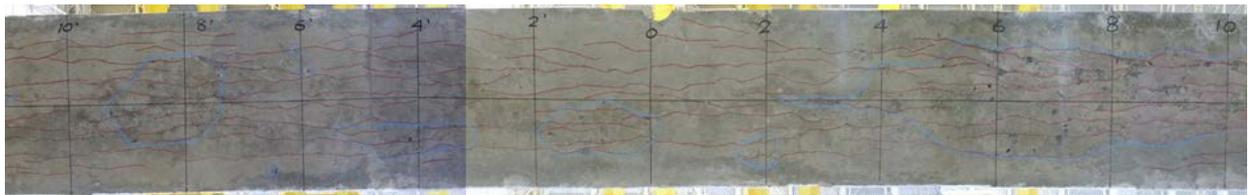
G3桁下面中央部のひび割れ状況 (実線:ひび割れ幅 0.04mm 以上) ひび割れ密度 25.3m/m<sup>2</sup>
